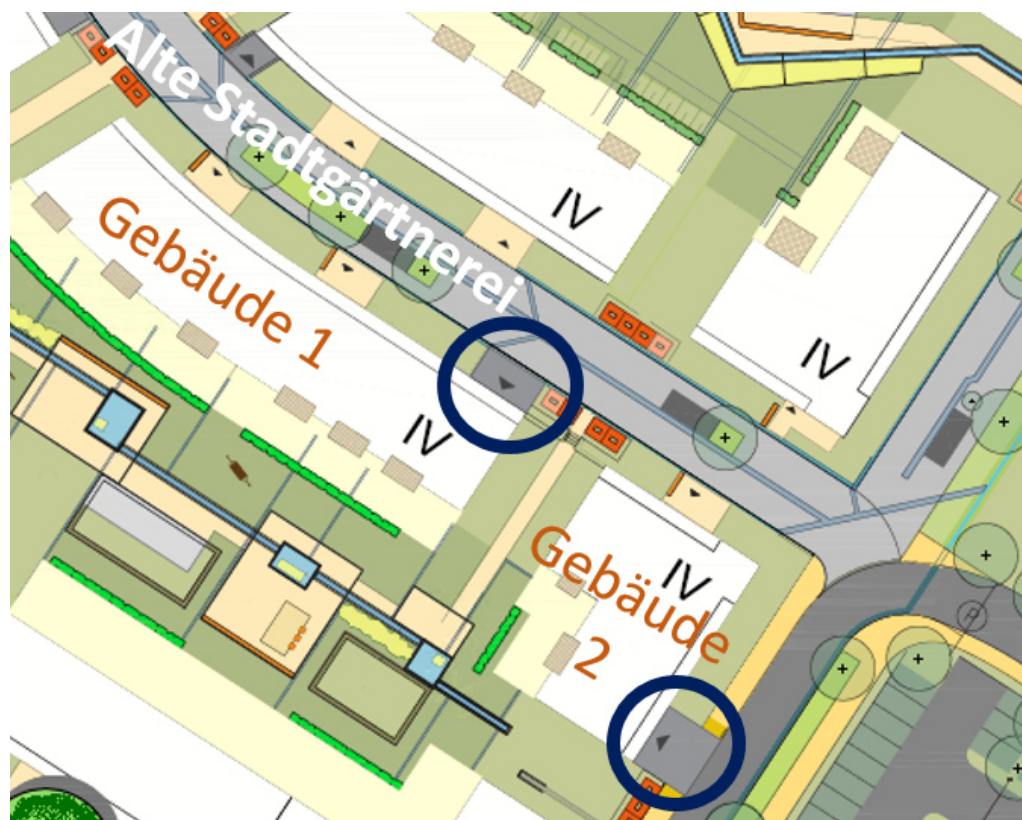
Lage der Tiefgaragenzufahrten im städtebaulichen Entwurf
